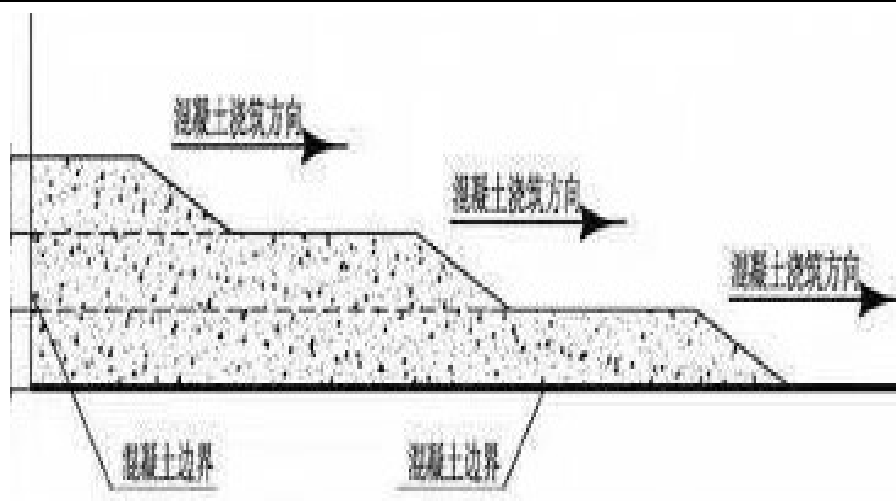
大体积混凝土分段（块）分层浇筑方法
